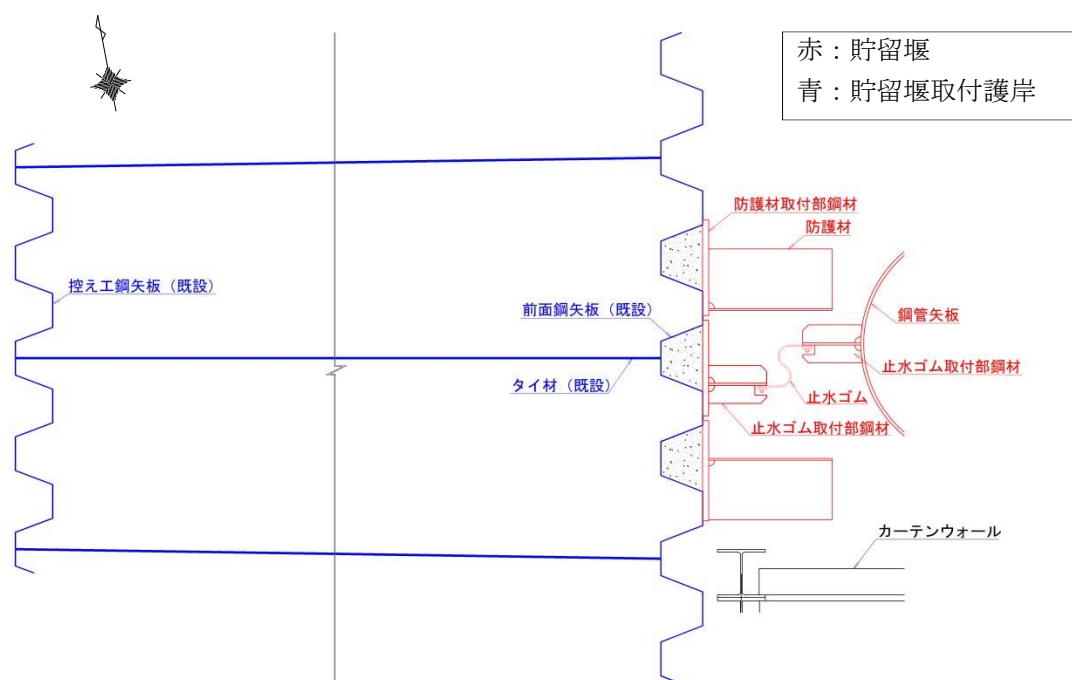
(2) 貯留堰取付護岸の平面図 (A 部拡大)
